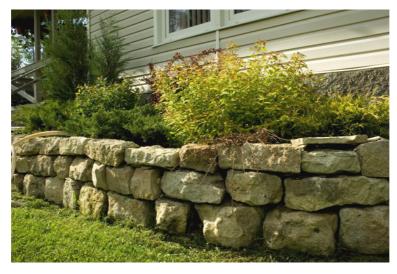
Подпорная стенка, выполненная методом сухой кладки
